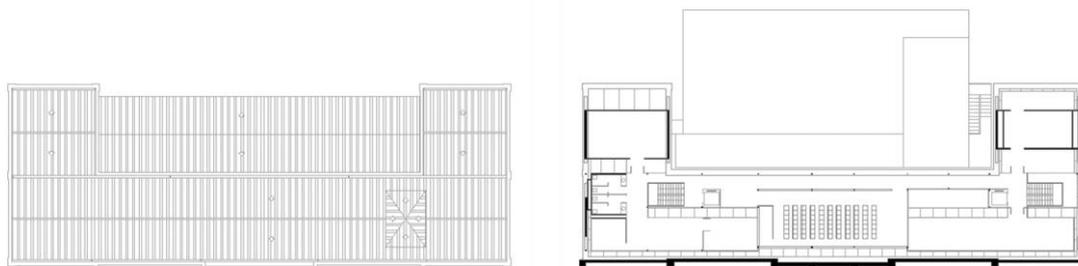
Planta de cubiertas. Edificio original / Edificio Rehabilitado.
